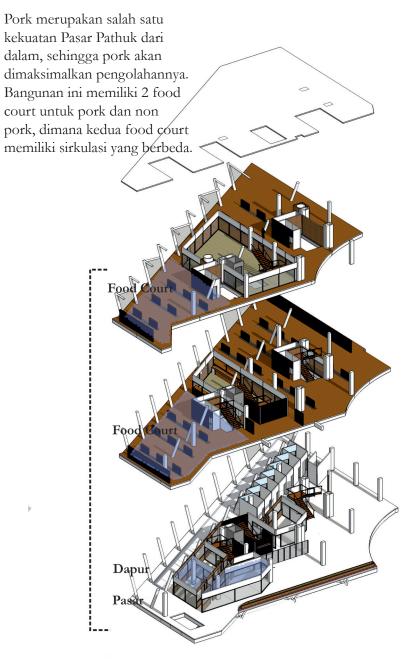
Sirkulasi Pengujung Lantai 1
